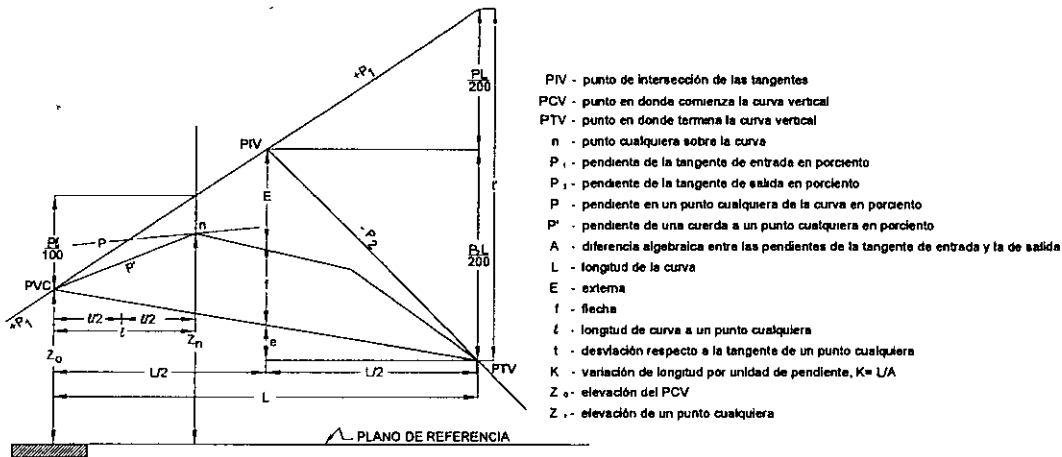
ELEMENTOS DE LAS CURVAS VERTICALES
